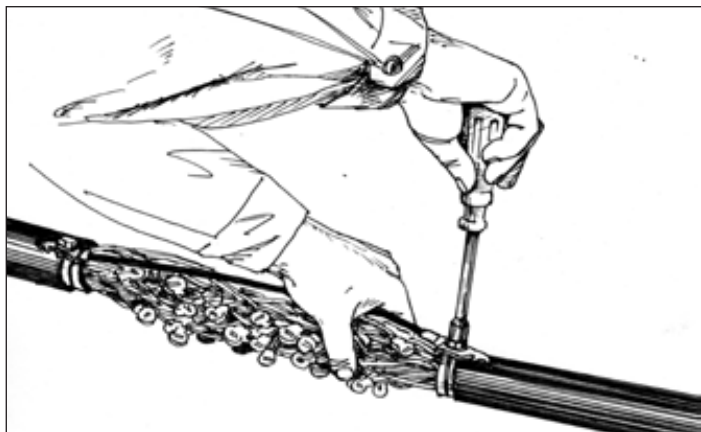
Установка провода экранирующего (провода соединения экрана)
